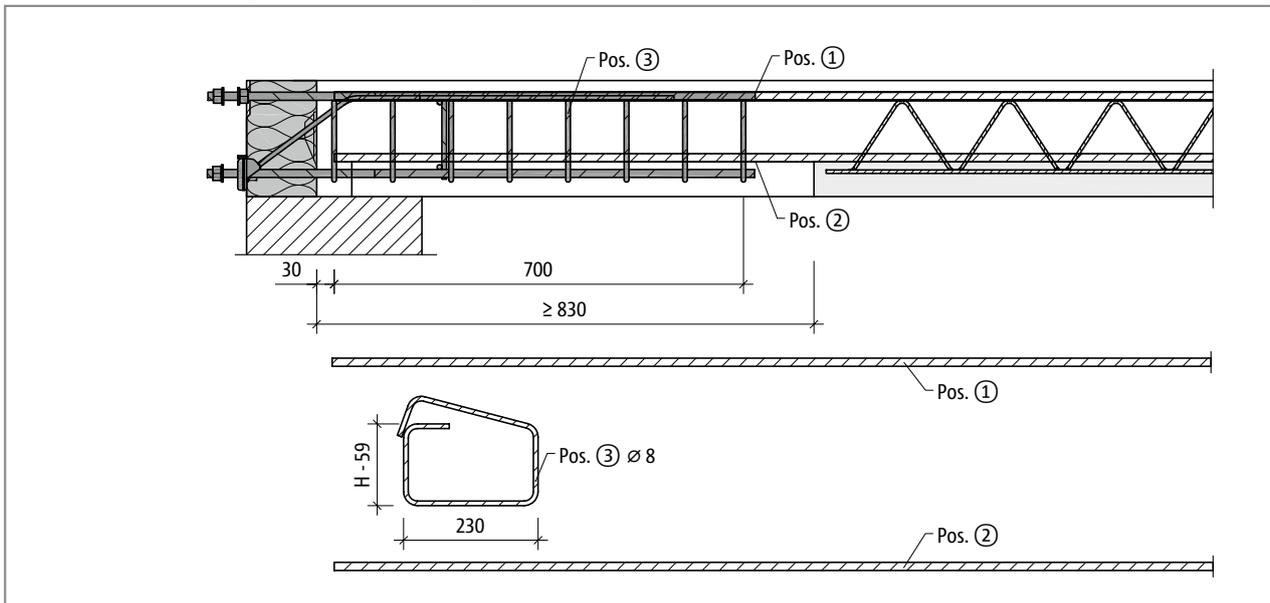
Schöck Isokorb® XT Typ SK-MM1-VV1: Bauseitige Bewehrung bei Halbfertigteilbauweise, Schnitt
